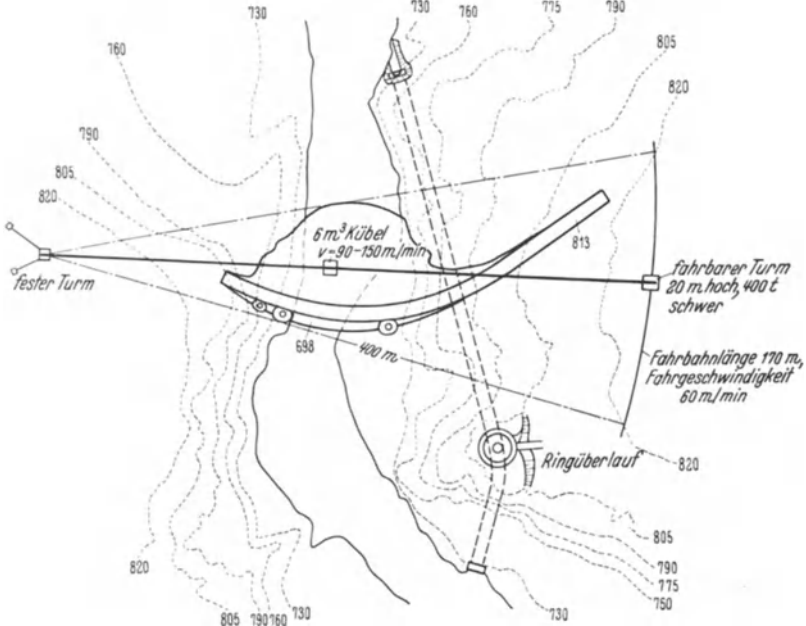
Kabelkrananlage zum Betonieren der Owyhee-Staumauer (USA.). Einzubringender Beton 380000 m³. Erzielte Stundenleistung 100 m³.
